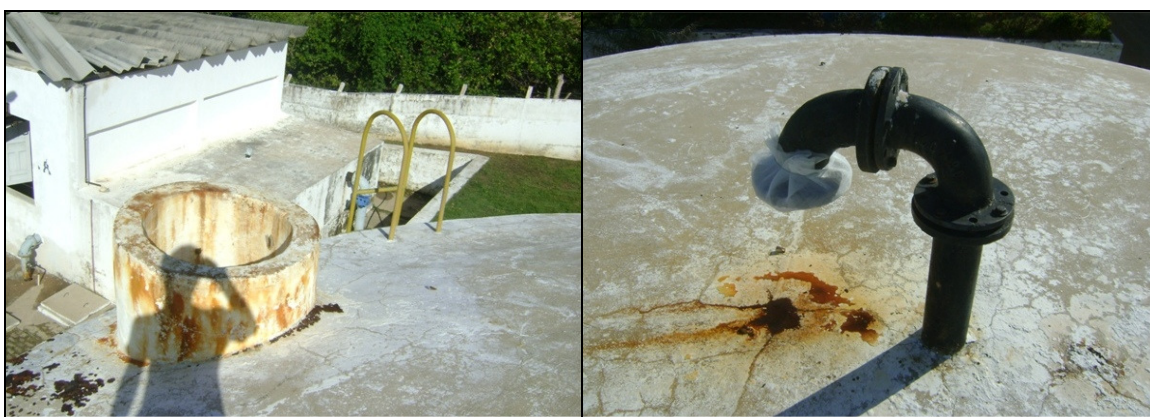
Inspeção e escada de acesso do RAP-01. Foto 34 – Ventilação do RAP-01.
